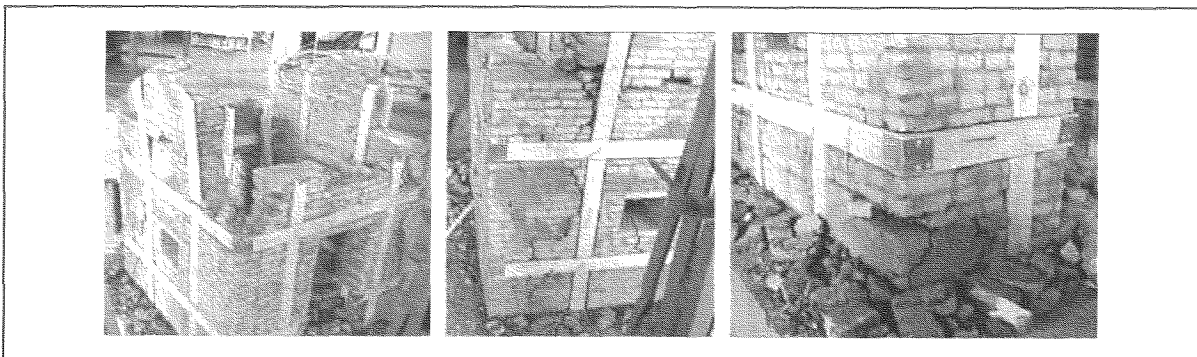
Grietas y daño marcados - Vivienda II
